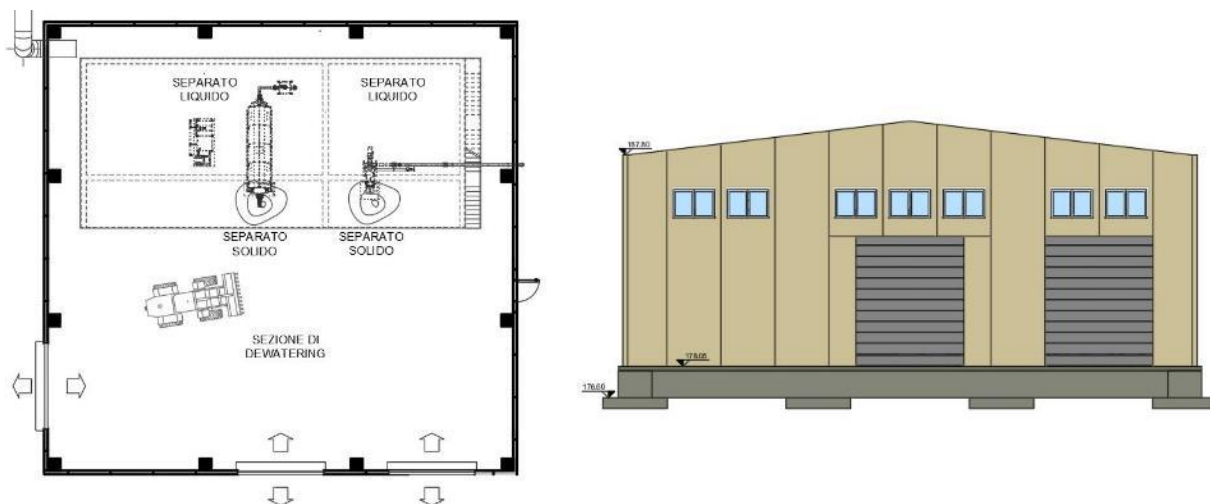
Planimetria e prospetto Ovest del capannone di post-trattamento del digestato
